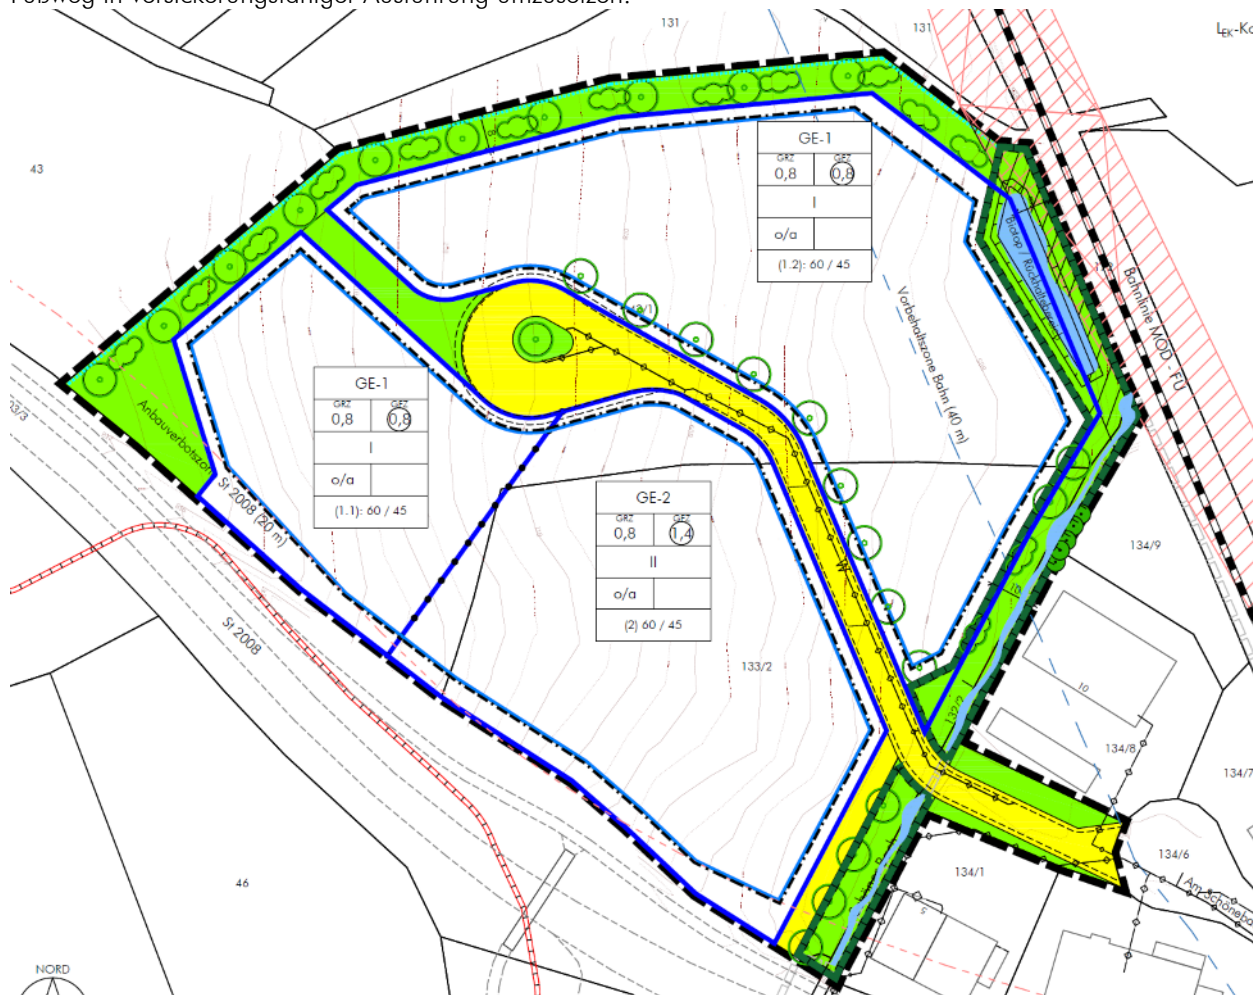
Planzeichnungsausschnitt 4. Änderung des BBP Nr 5. „GE Osterreuten - West“
